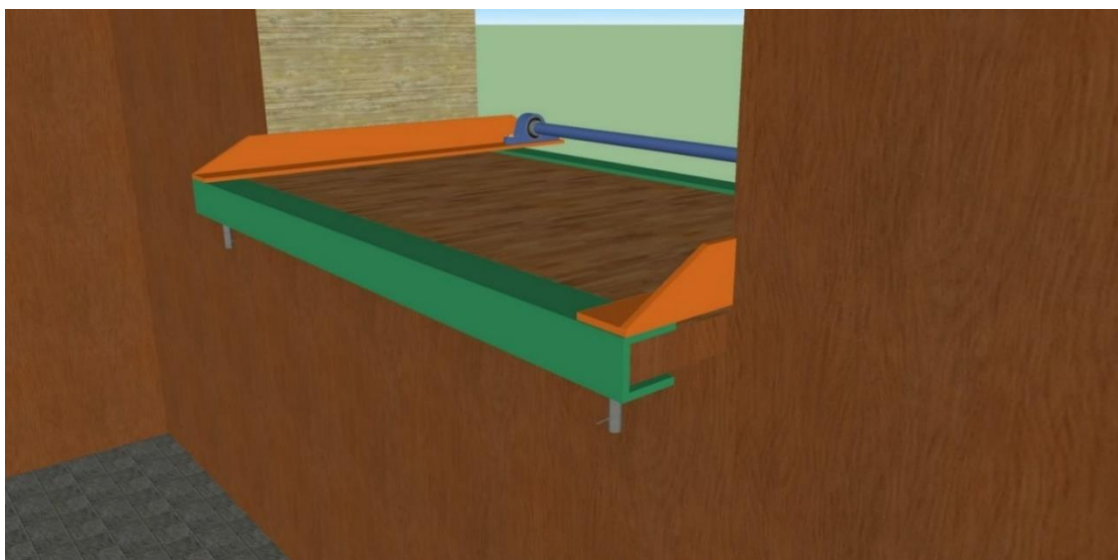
Расположение устройства (конструкции) – вид изнутри
